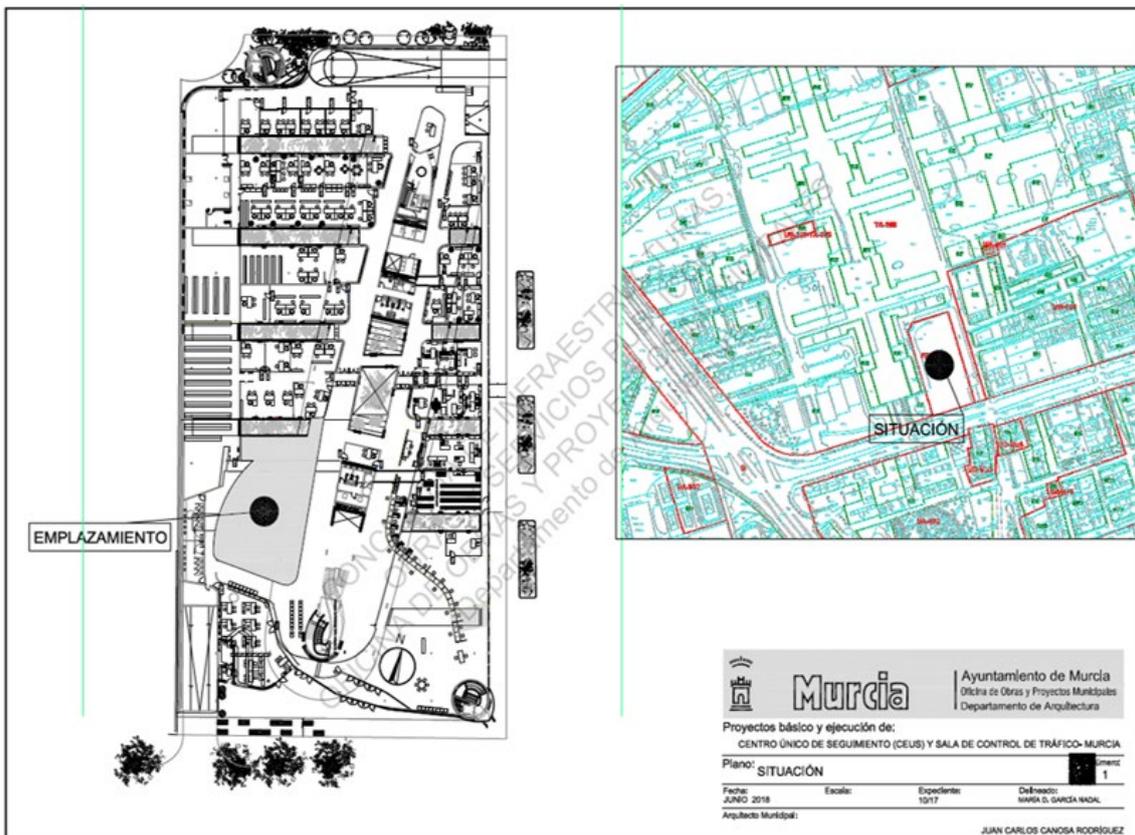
Plano de la planta del Edificio Abenarabi donde se ubica el Centro Único de Seguimiento CEUS.
